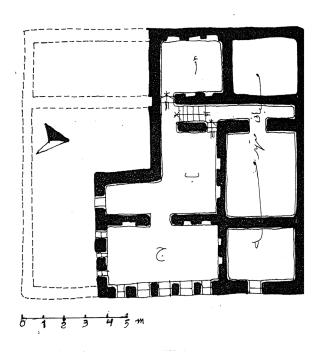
منزل ابو همام الدور الثاني – مسقط أفقى
